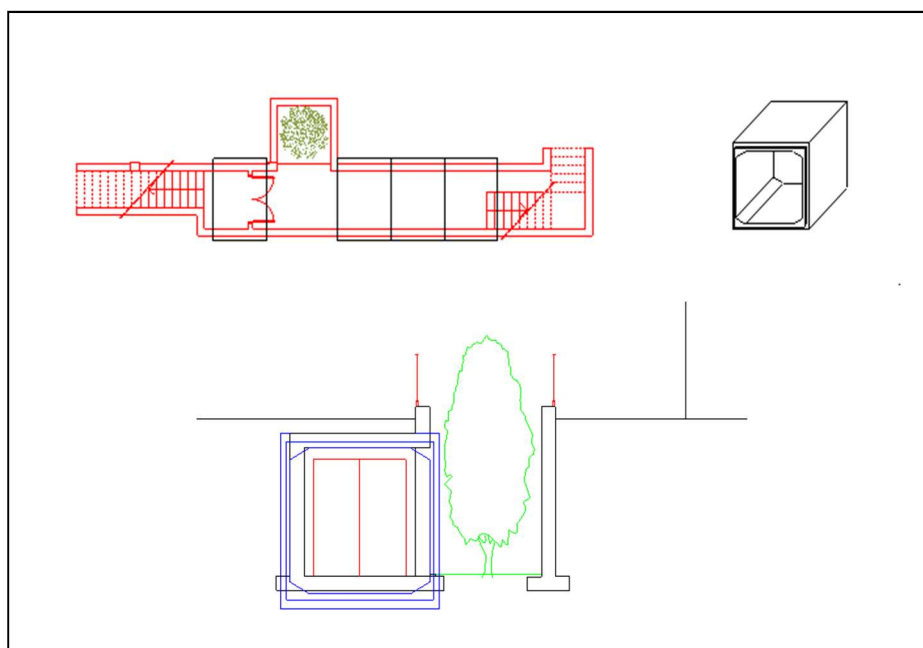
Planta e corte do túnel exemplificativos da colocação de “Box-Culvert” monobloco
